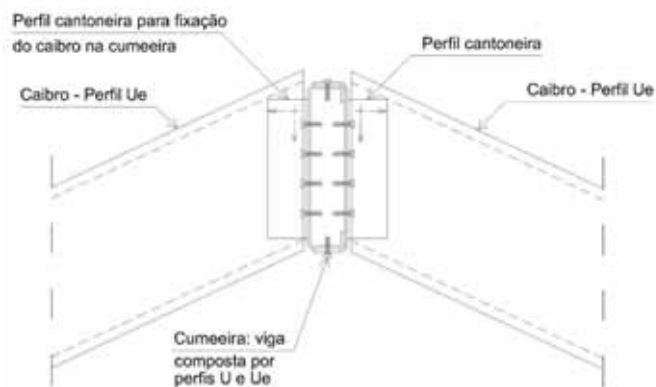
Cumeeira de telhado estruturado com caibros.
